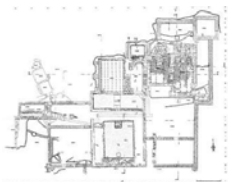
e 34- Planta e corte de estruturas das termas de Tongóbrica - Marco de Canavezes
